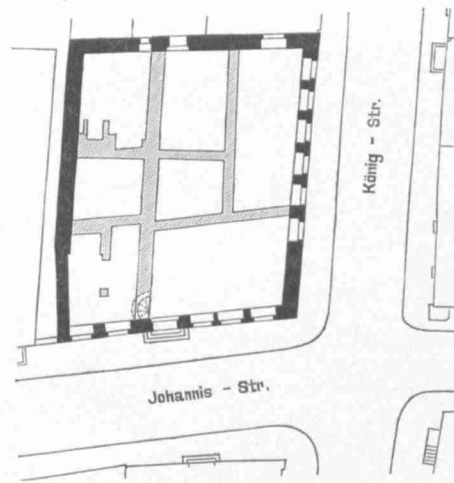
Alter Grundriß mit eingezeichneten Kellermauern.
